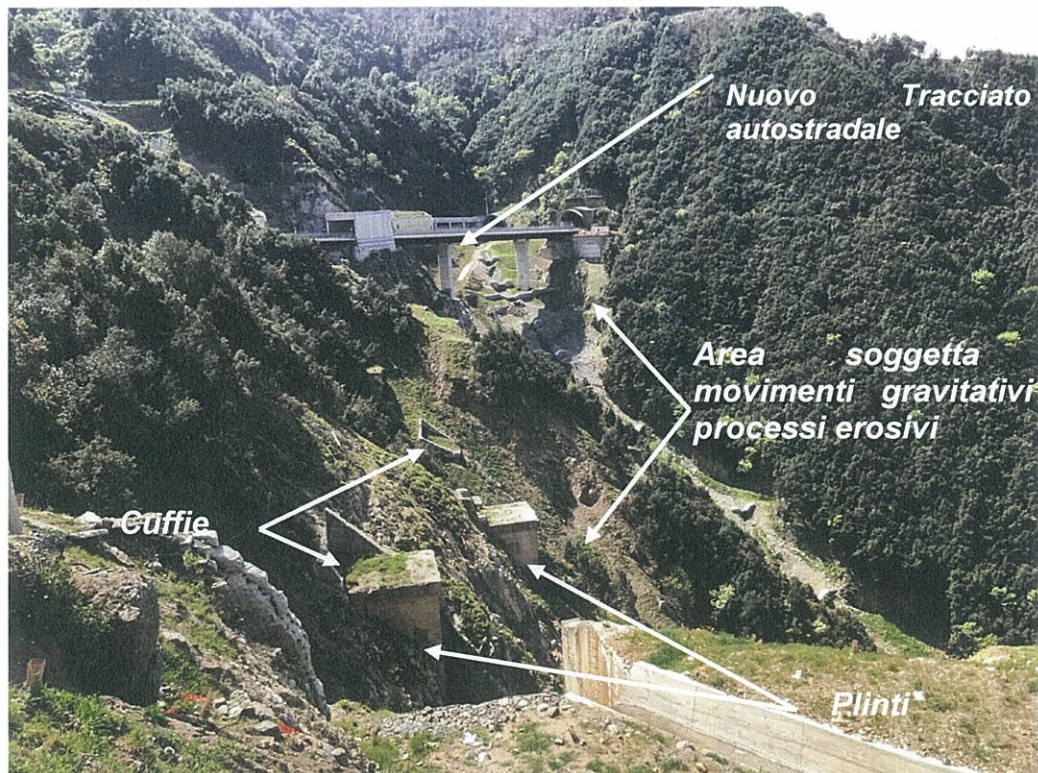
Panoramica del viadotto Feliciusu: con evidenza del ruolo a favore della stabilità assunto dalle opere, lungo la porzione di versante, caratterizzata da pendenze elevate.
